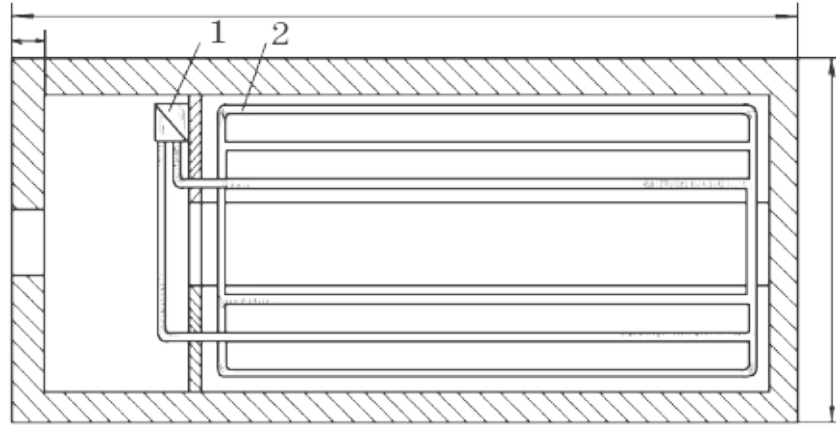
План зимней теплицы с кирпичными стенами: 1 — водогрейный котел; 2 — отопительные трубы
